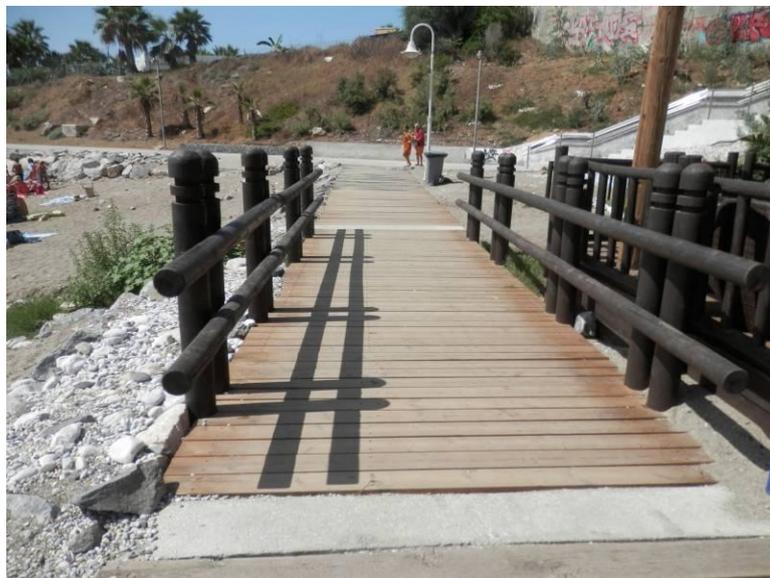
Puente sobre cauce para evacuación de pluviales
